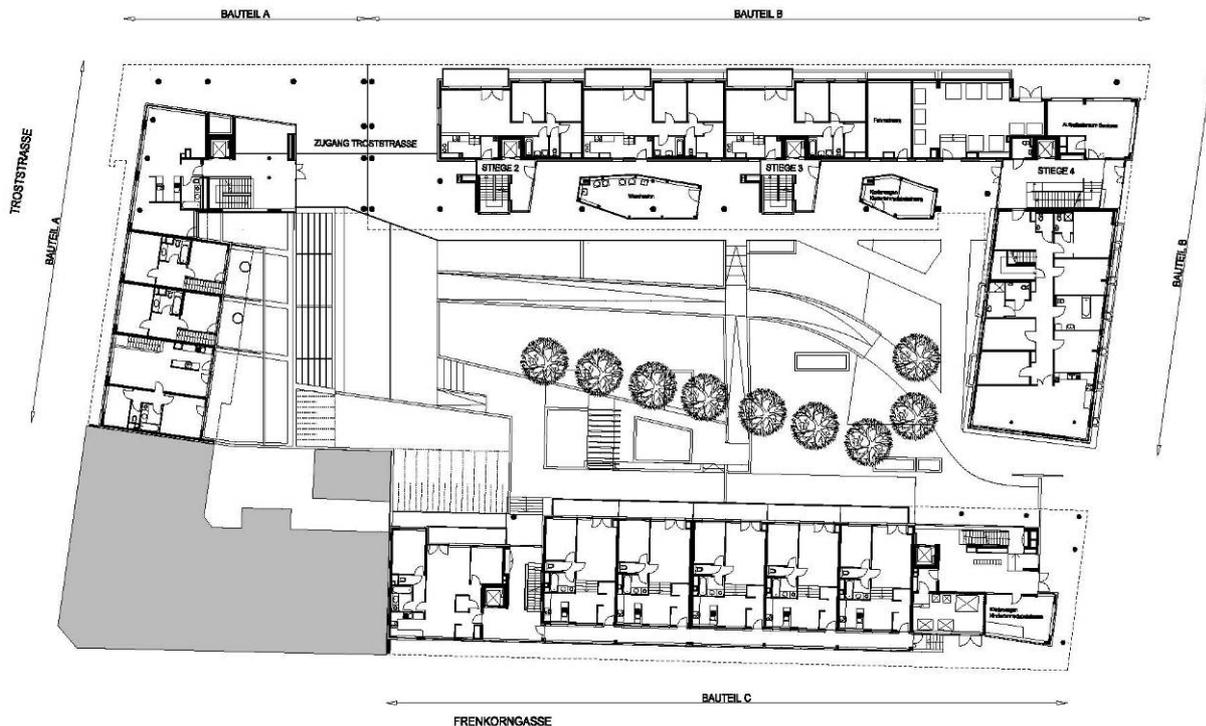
Frauen-Werk-Stadt II, Erdgeschoß und Lageplan; maßstabslos. Quelle: Arch. Zwingl
